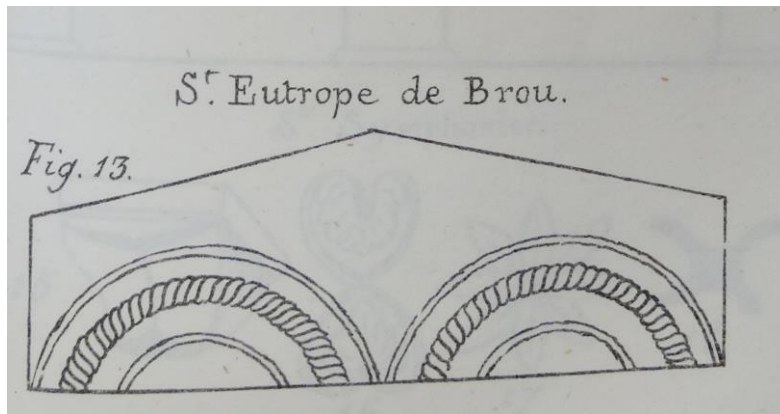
et 8 : (Arcatures plaquées de la façade de l'église de Broue extraits de l'ouvrage de Lesson 1842, planches 3 et 4)
